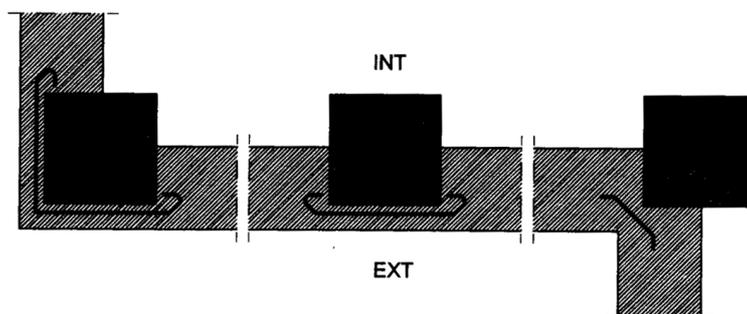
Ejemplo de encuentro de la fachada con los pilares
